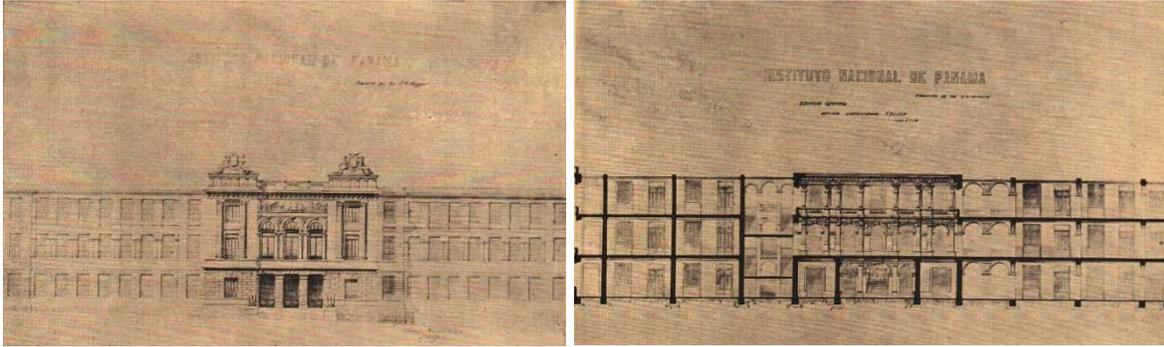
Planos (fachada y sección) del Instituto Nacional firmados por Gennaro Ruggieri. Fuente: (Memoria de Fomento, 1910).
